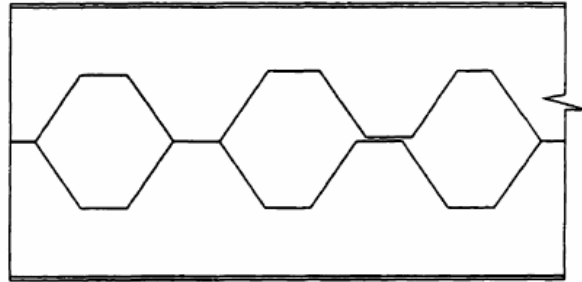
Ruine par écoulement du joint de soudure [13]
